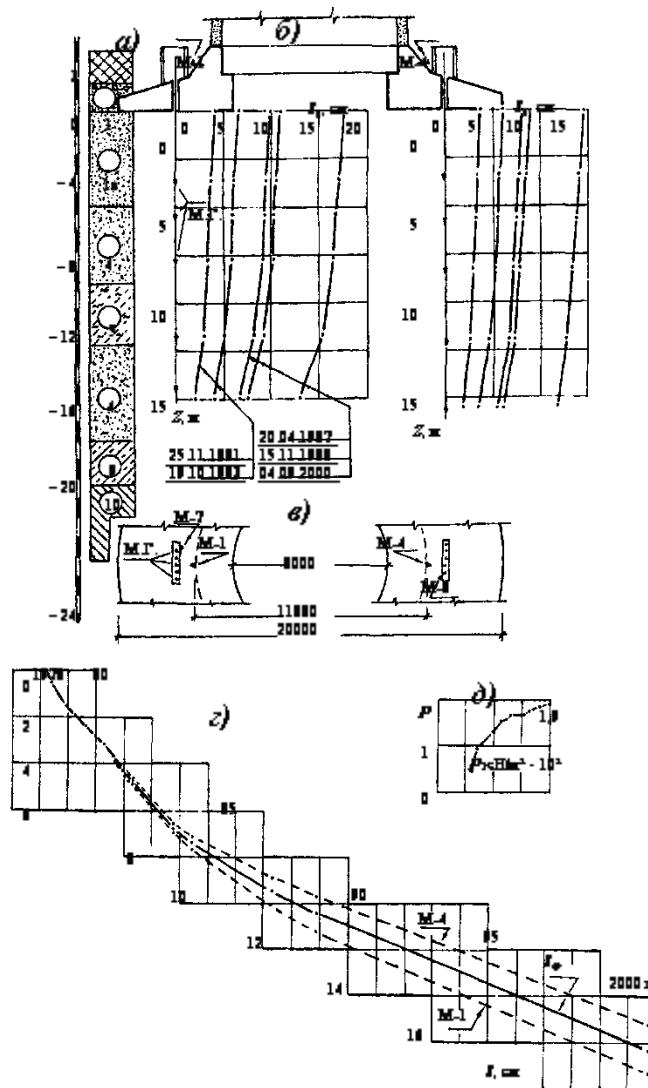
Схема расположения глубинных марок и эпюры послойных перемещений; а) геологическое строение основания; б) поперечное сечение фундамента. Схема расположения глубинных марок. Эпюры послойных перемещений; в) фрагмент плана фундамента со схемой размещения глубинных (М.Г.) и ственных (М) марок; г) график нарастания осадок фундамента: средней, минимальной и максимальной во времени; д) график роста давлений в период строительства.
